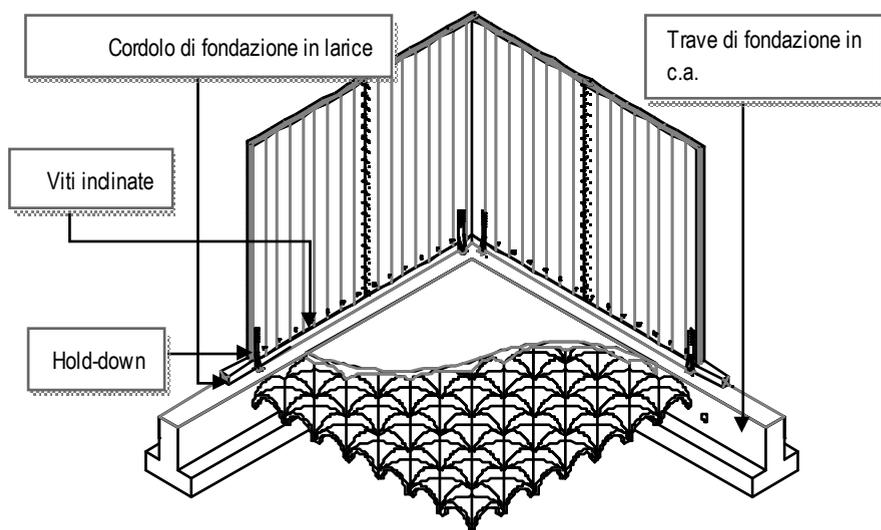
Collegamento alle fondazioni per un edificio XLam con cordolo di larice, tirafondi, viti e hold-down.
